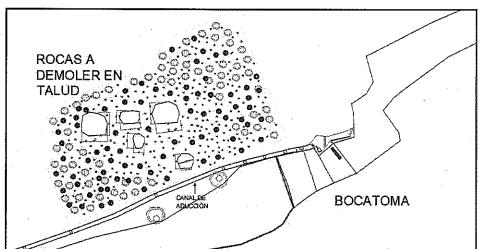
Plano en planta de la zona a intervenir. Fuente: INFORME INTERVENCIÓN DE ROCAS CONTIGUAS AL CANAL
